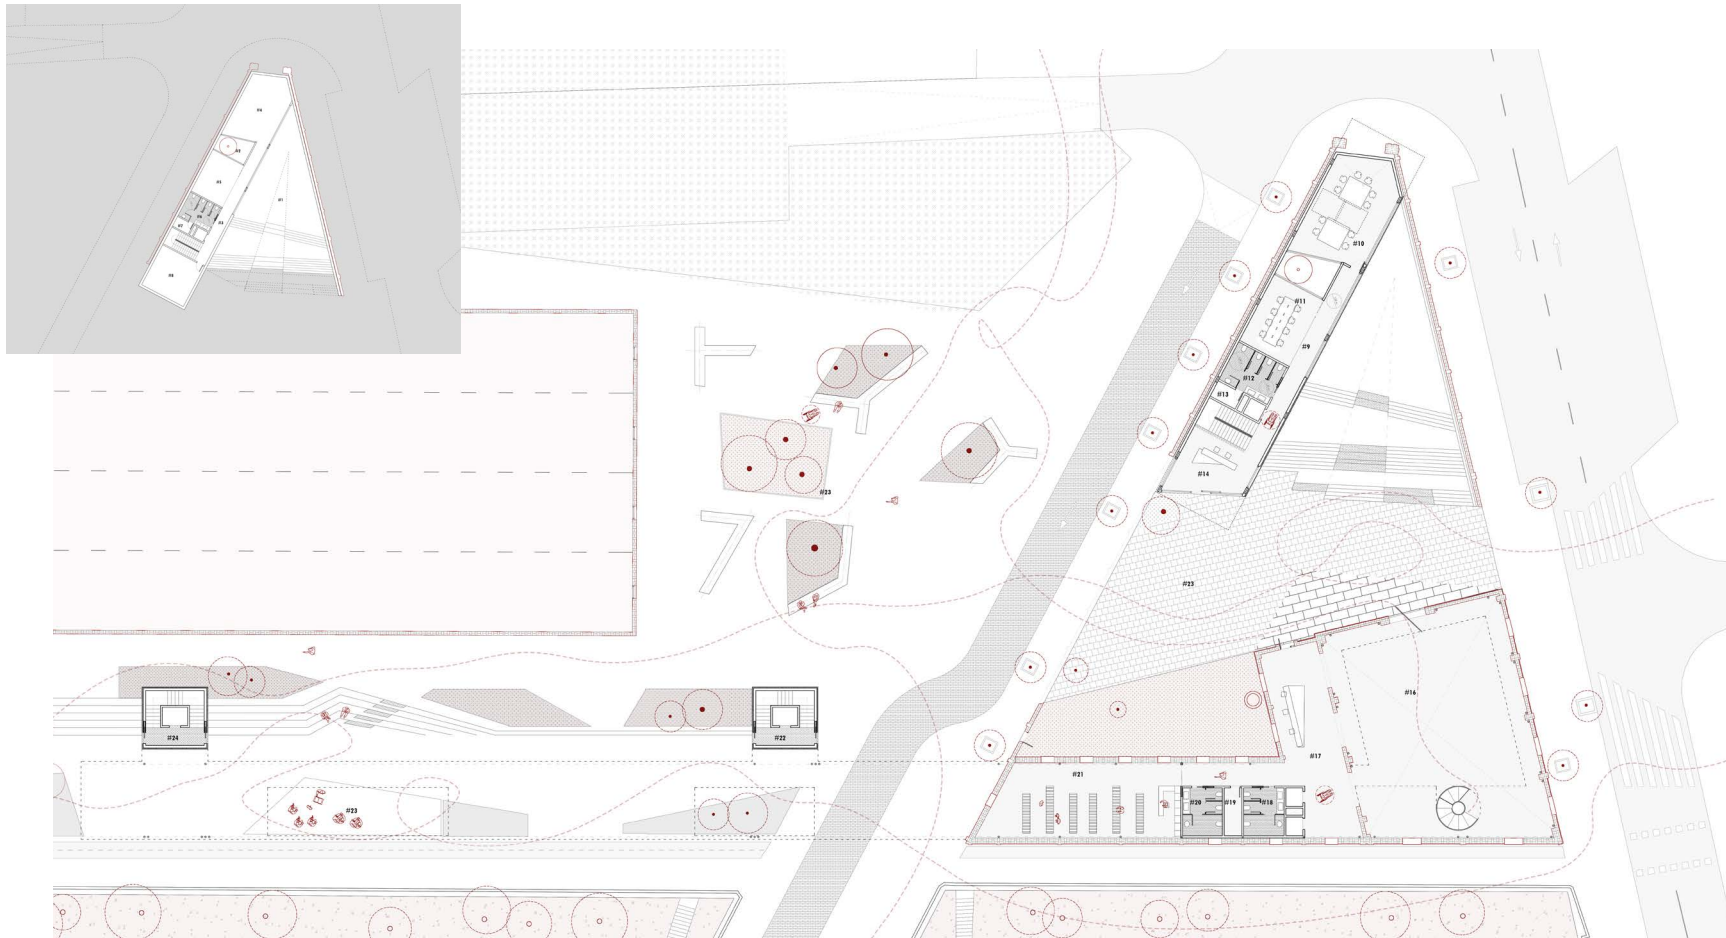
Planta Primera y Planta Sótano. Elaboración propia.
